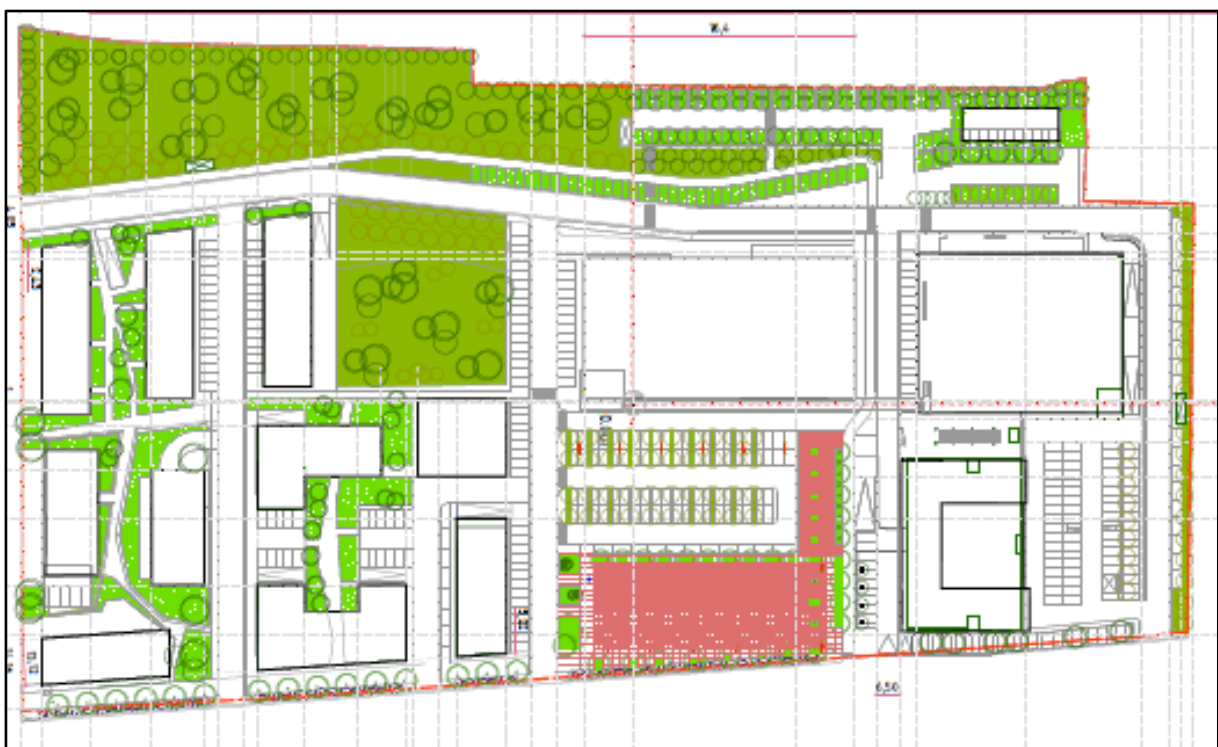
Planimetria distribuzione del verde e spazi pubblici a piazza
